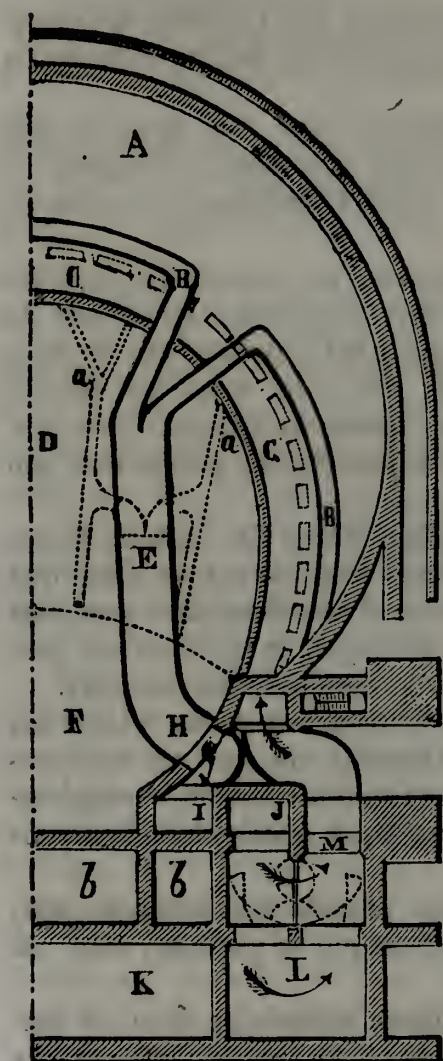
Palais du Trocadéro, 1/2 Plan de la ventilation.
